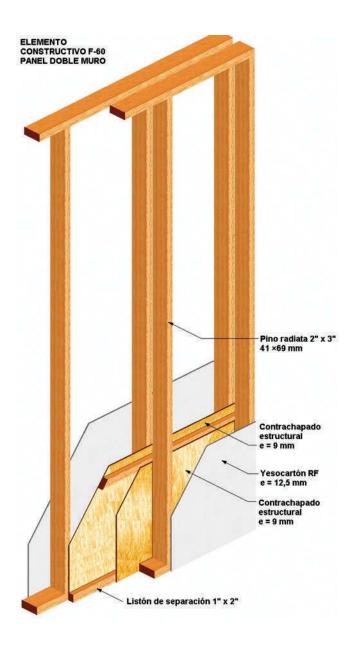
31: Elemento constructivo cortafuego tipo panel doble muro F-60, Fundación Chile.
